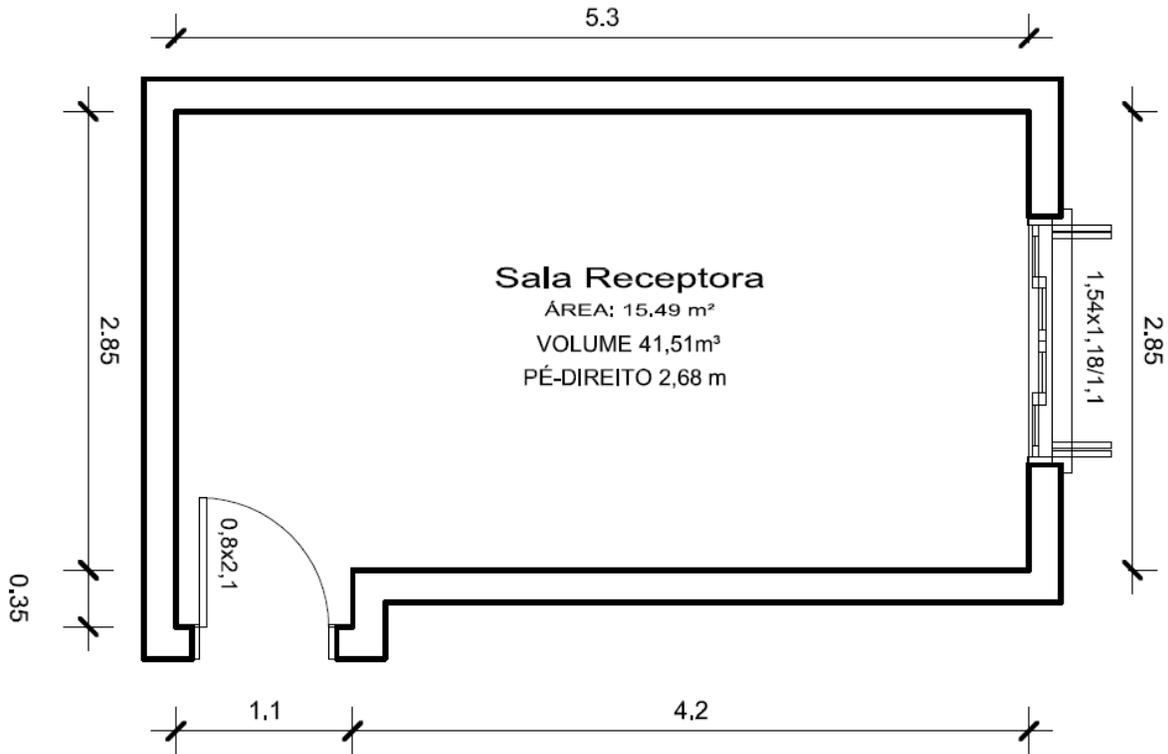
Planta baixa da sala receptora, tipologia de laje: Pré-Laje.
